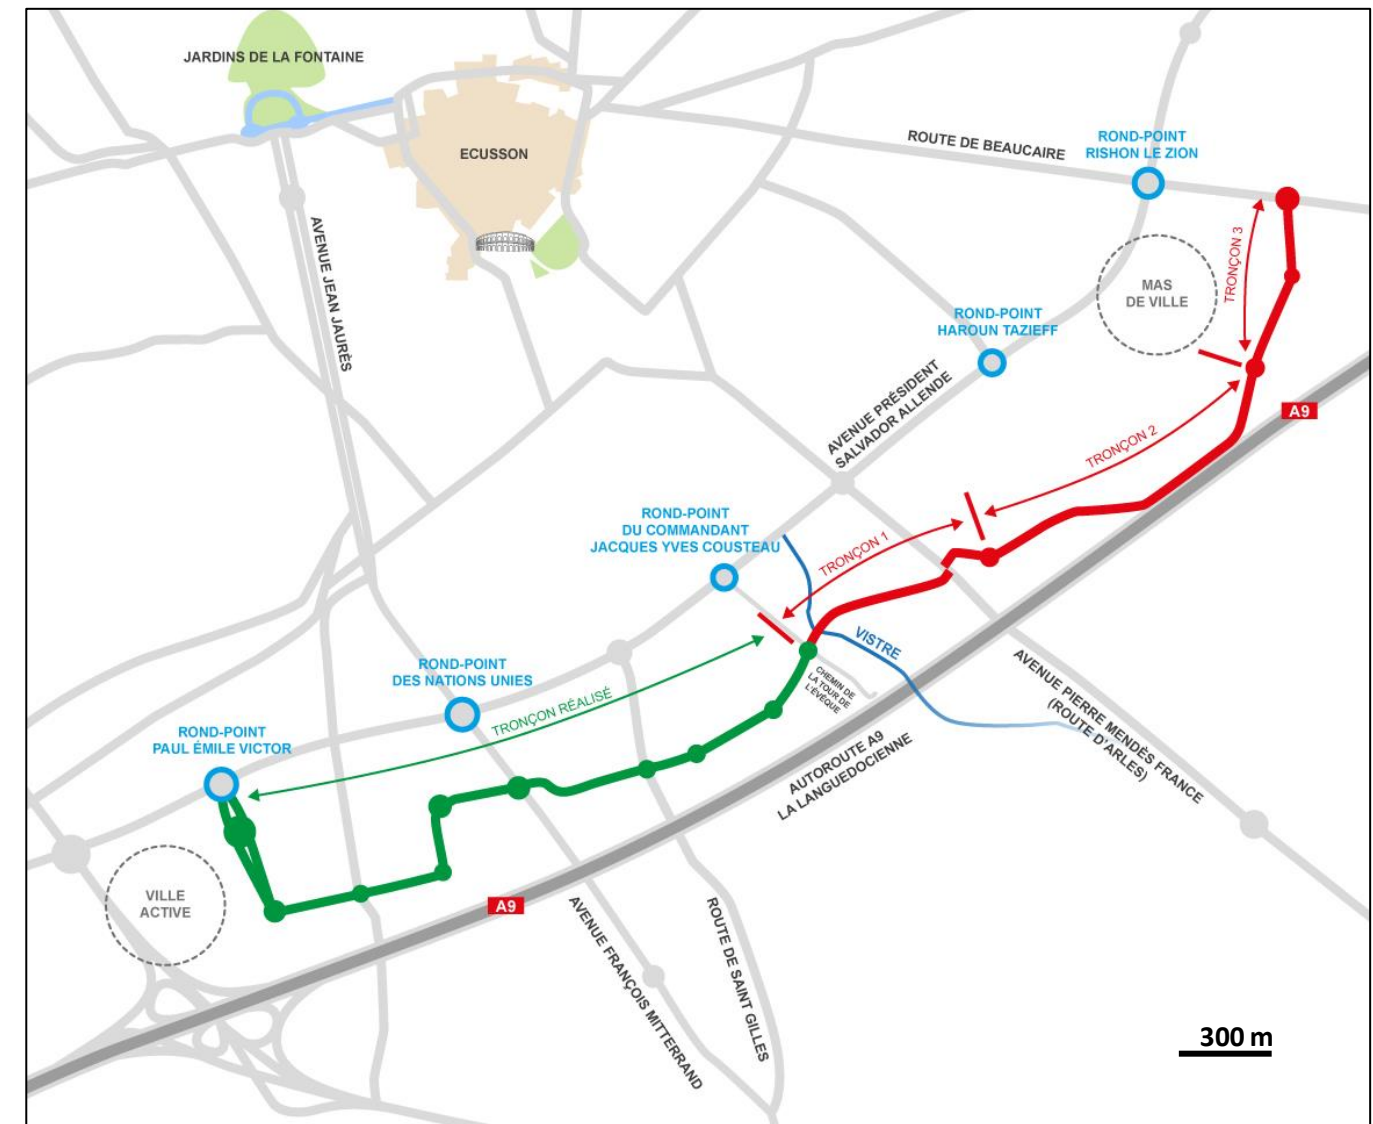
PLAN PREVISIONNEL DU TRACE DE LA VOIE URBAINE SUD DE NIMES
